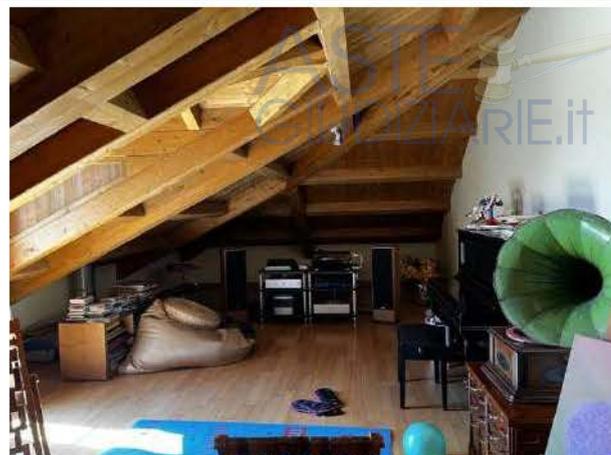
Diverse viste del sottotetto adibito a sala relax, fitness e tempo libero con presenza di lucernari, in tradosso a vista in legno lamellare e pavimentazioni in parquet ed arredi fissi con funzione espositiva.
